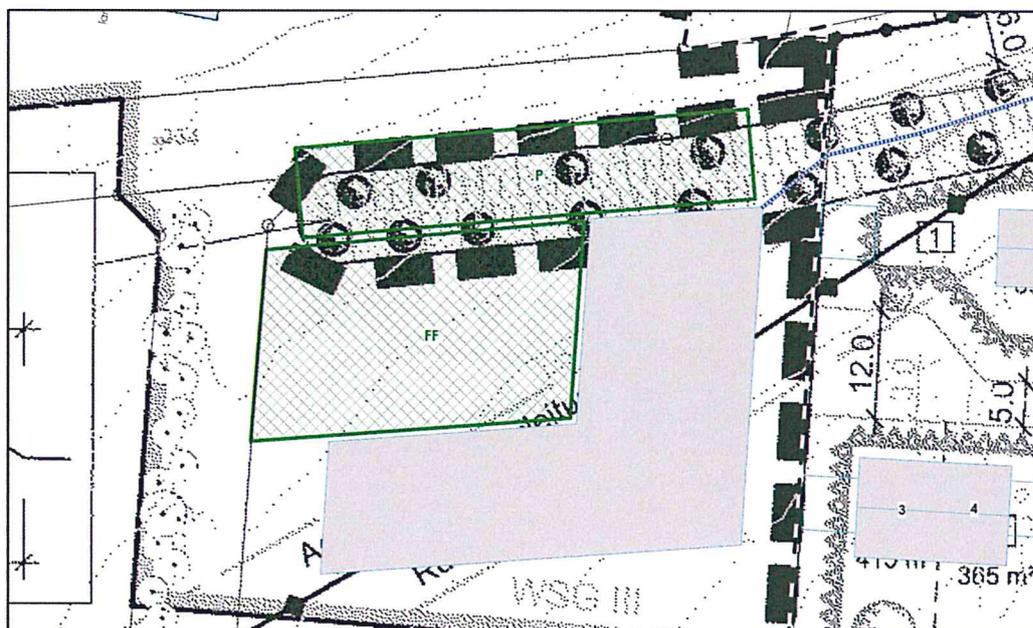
Lageplan mit Darstellung der relevanten Schallquellen
